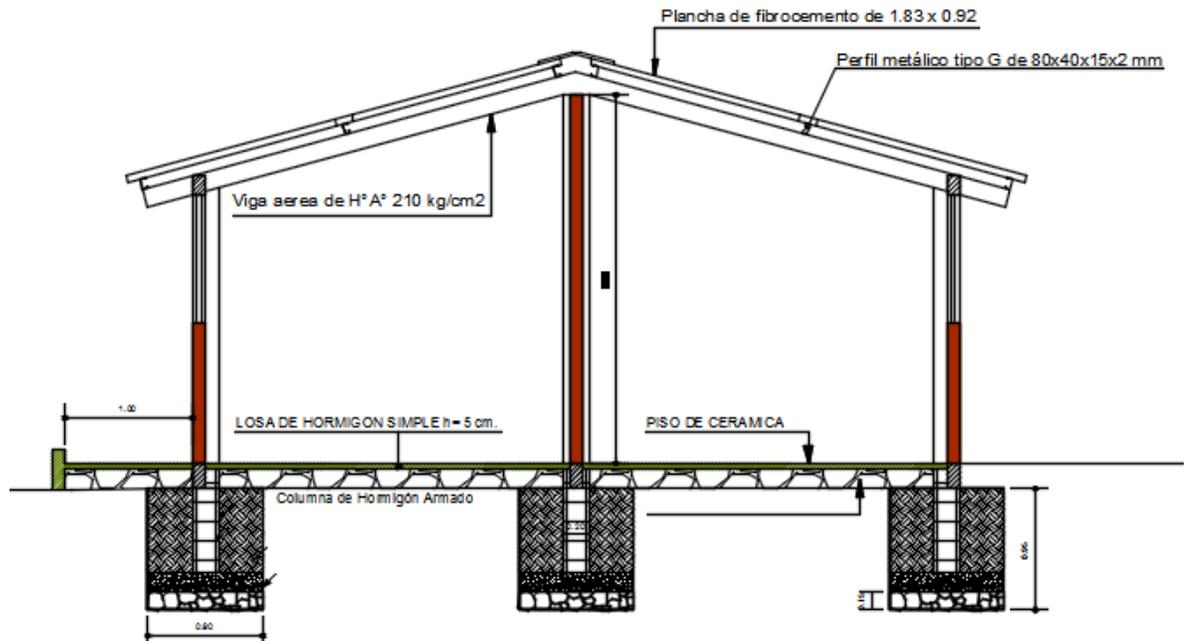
Detalle pórtico vivienda MIDUVI año 2012.
